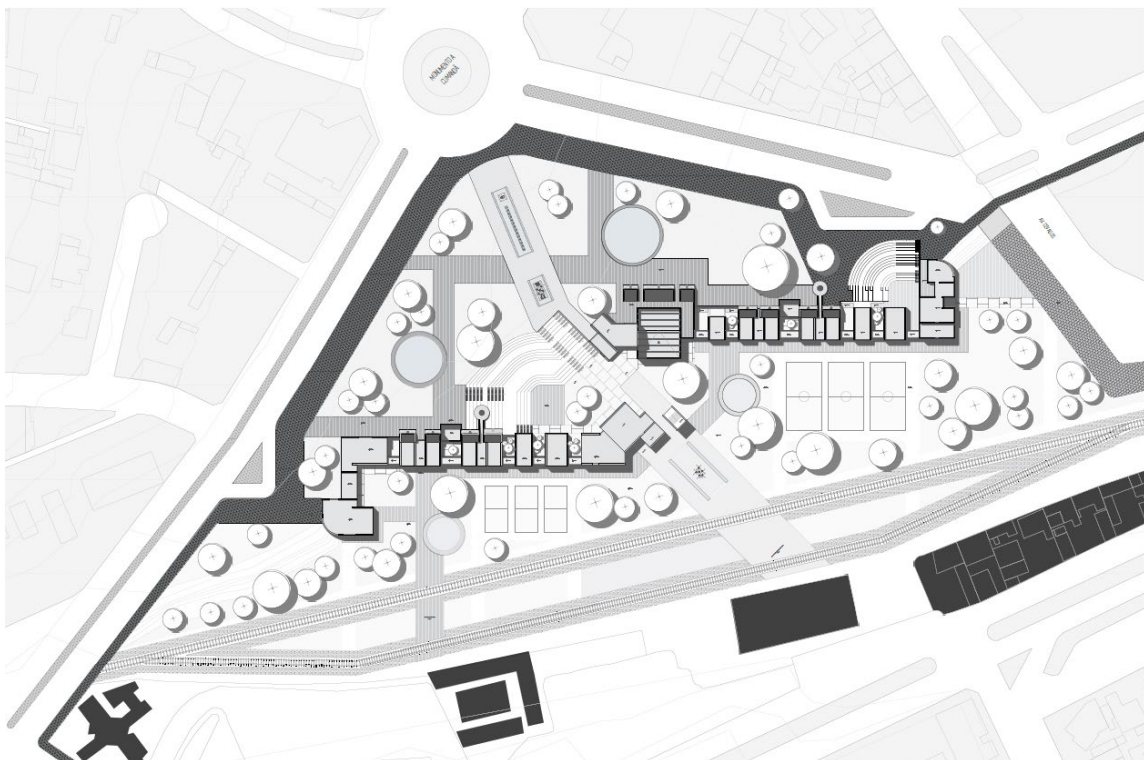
Implantación general del proyecto arquitectónico. Caraguay (2021)
